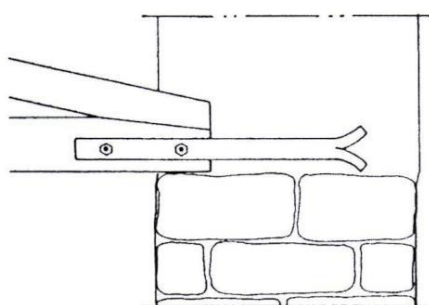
Representação esquemática de apoio de viga na alvenaria [5]
